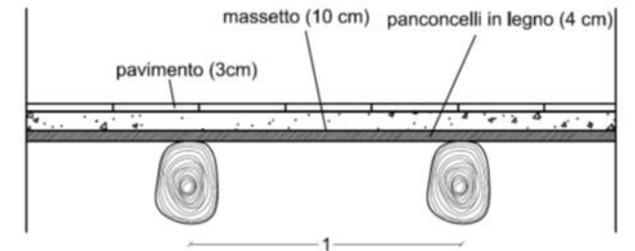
Sezione trasversale del solaio oggetto d'intervento
